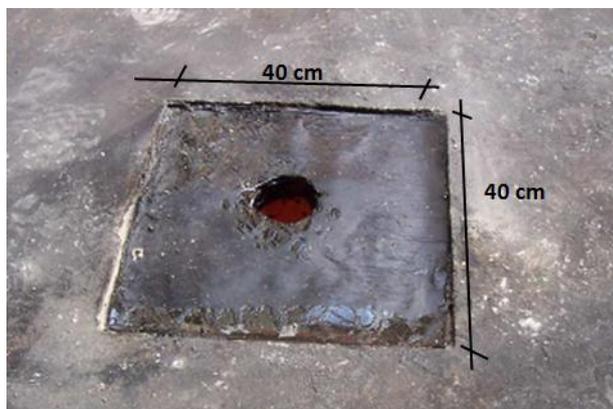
Detalhe do ralo já executado – Fonte: Cetimper
